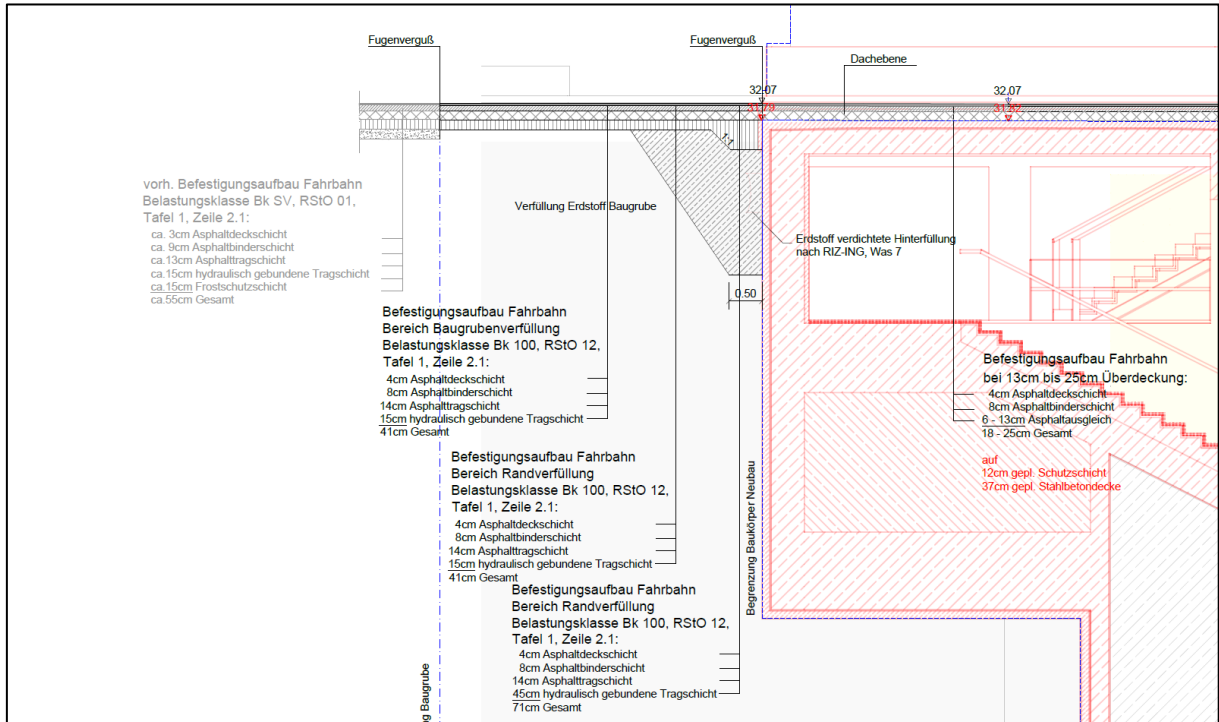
Konstruktionsaufbau mit verdichteten Randverfüllung und HGT
